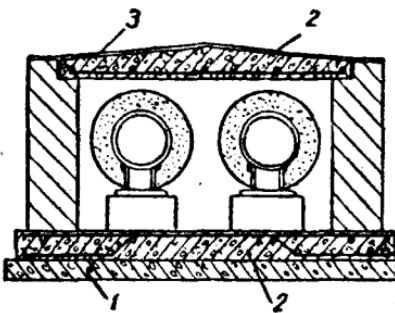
在松软土壤中所敷设的带有钢筋混凝土底板的管沟
